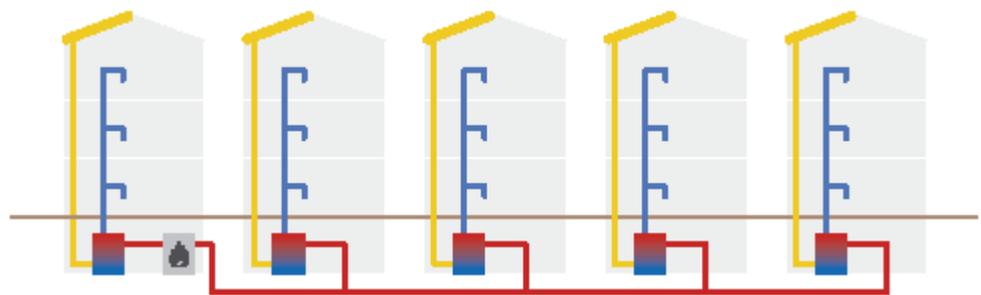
Prinzipschema Gebäudesituation: Warmwasser pro Gebäude, Heizwärme aus Zentrale
